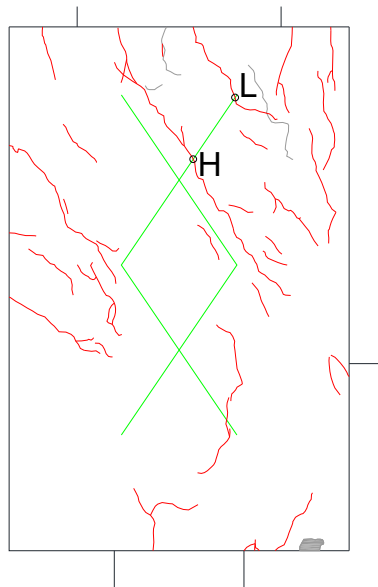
パイルキャップ危険断面位置ひび割れ幅測定位置 (試験体 D-4 負荷荷)
